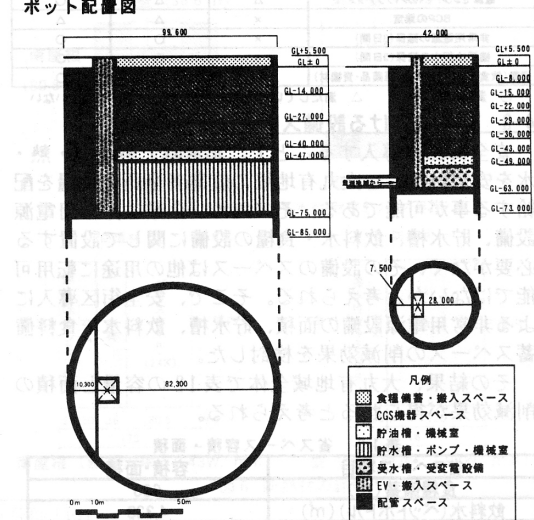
平面図・断面図(caseA) 図8 平面図・断面図(caseB)
